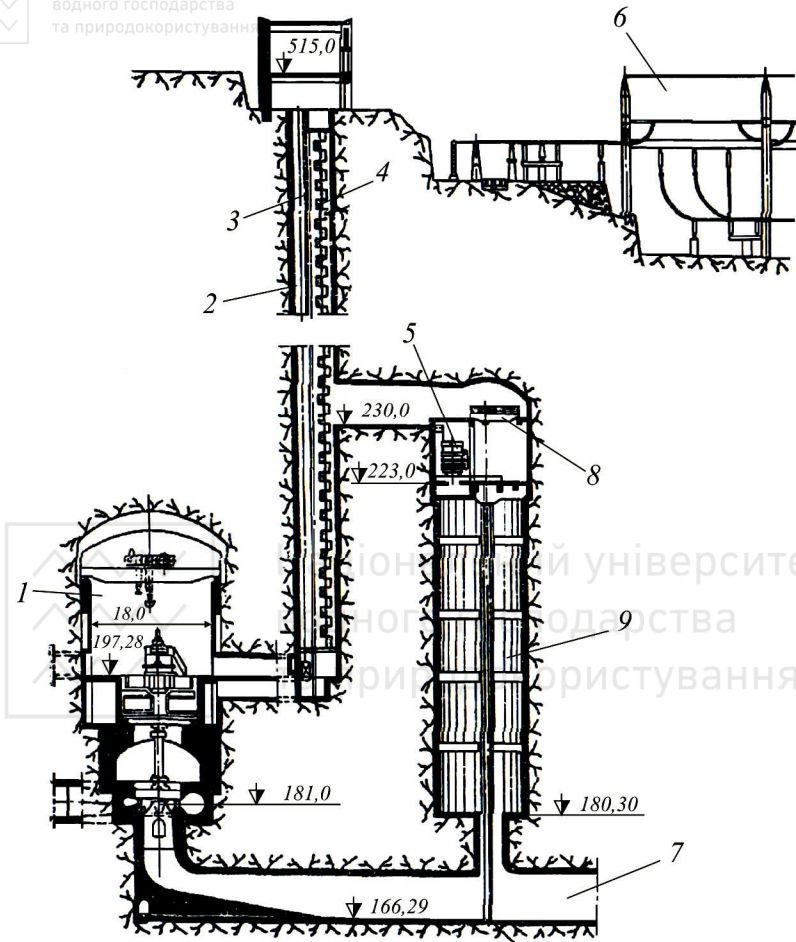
Поперечний переріз підземної будівлі ГЕС:
